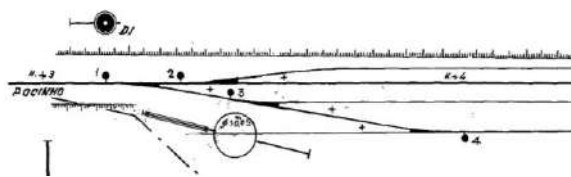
Planta da placa inversora do Apeadeiro do Carvalho. Adaptado do Anexo VI. 1952<sup>388</sup>
